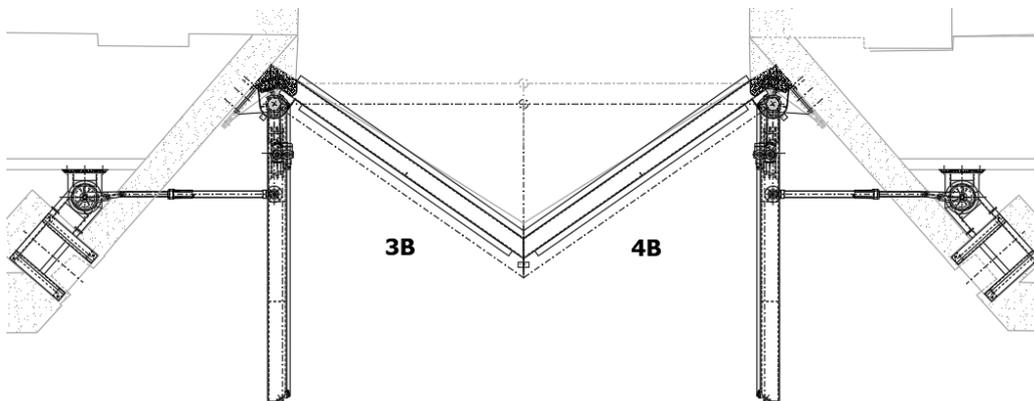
installazione cilindro elettromeccanico su porta 4B-3B – porte aperte
